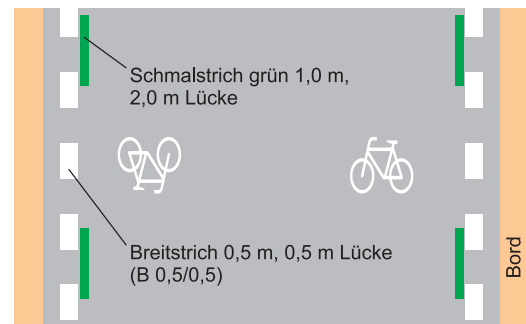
Prinzipskizze der Markierung einer Fahrradstraße auf einer Radvorrangroute
